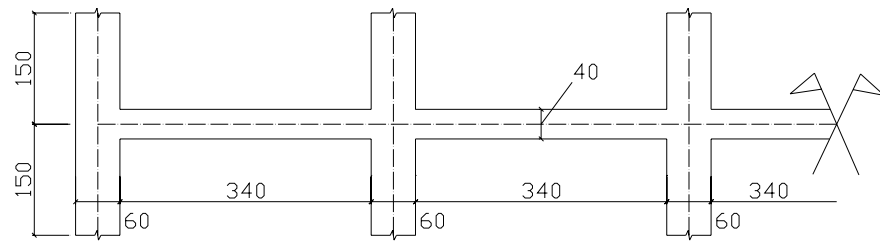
Geometria da viga, Caso 8 (dimensões em cm)
